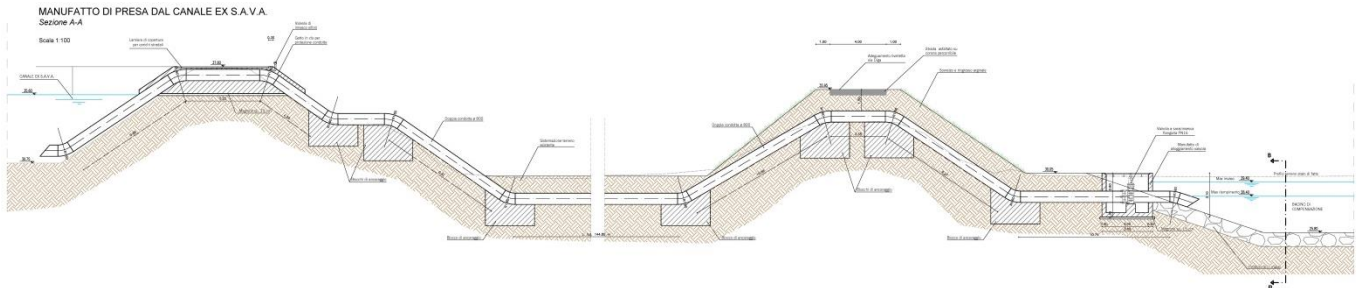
Sezione manufatto di derivazione dal canale Ex S.A.V.A..
